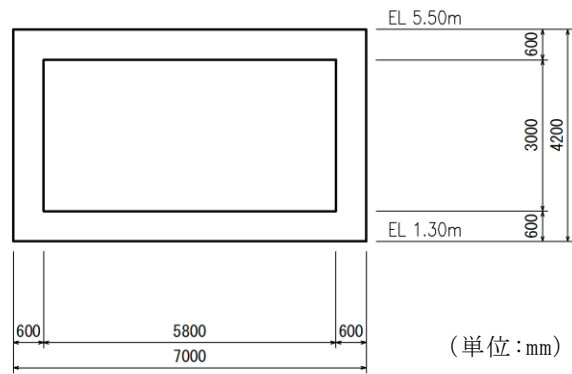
屋外配管ダクト (タービン建物～放水槽) 断面図 (A-A断面)
